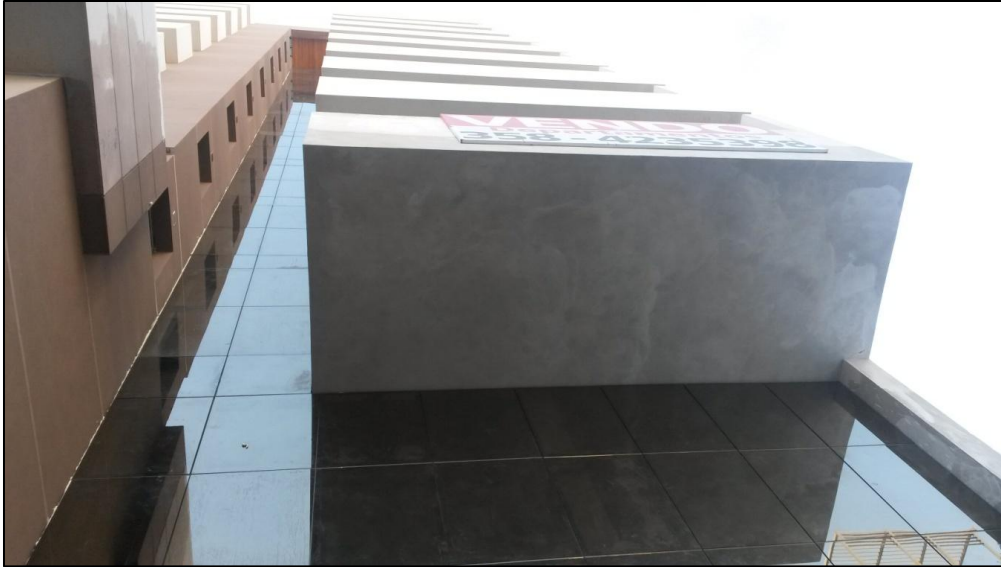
Piel de vidrio en fachada del edificio Puerta del Sol II.
